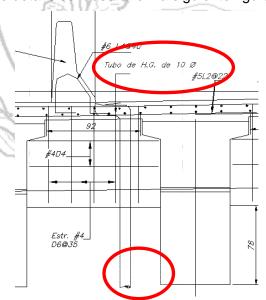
Detalle del plano para los ductos de drenaje en el puente sobre el Río Tenorio.
